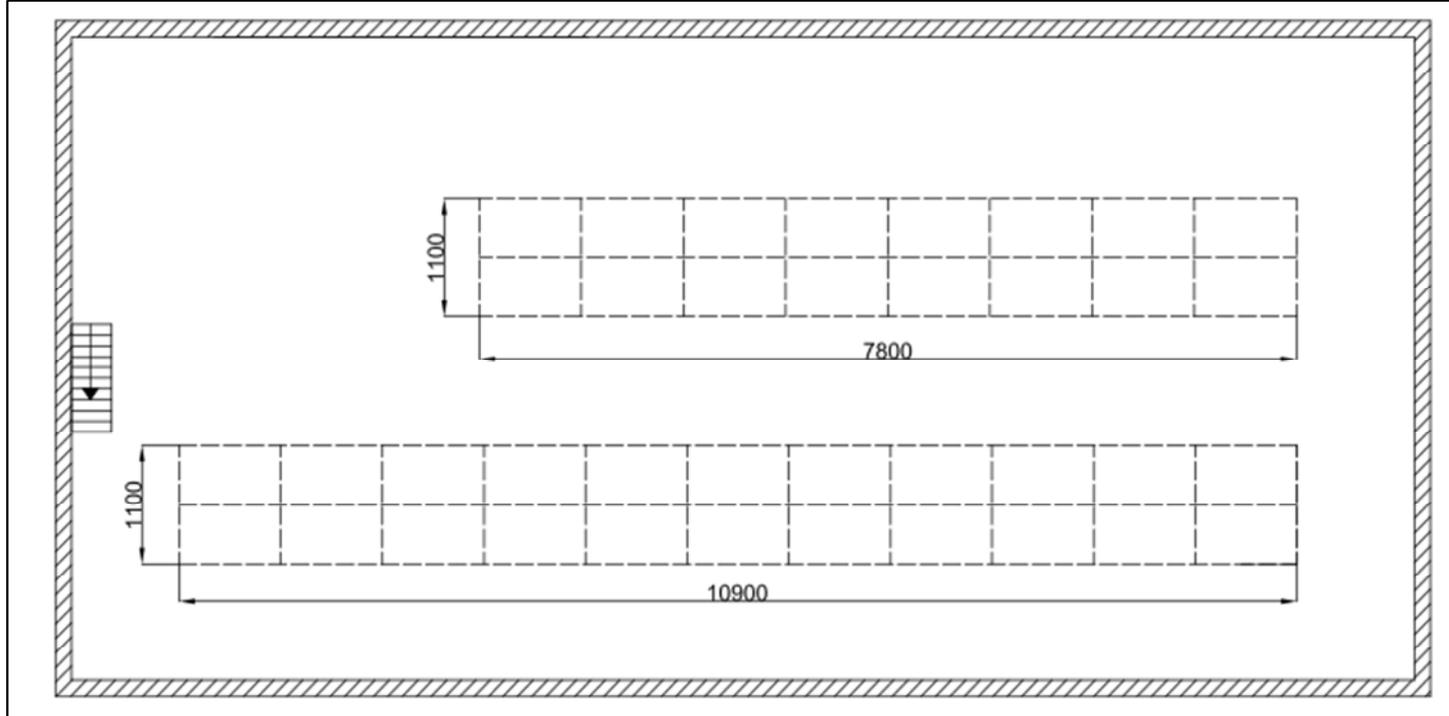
Propuesta de distribución en planta del almacén de insumo nivel II. Fuente: Elaboración propia
